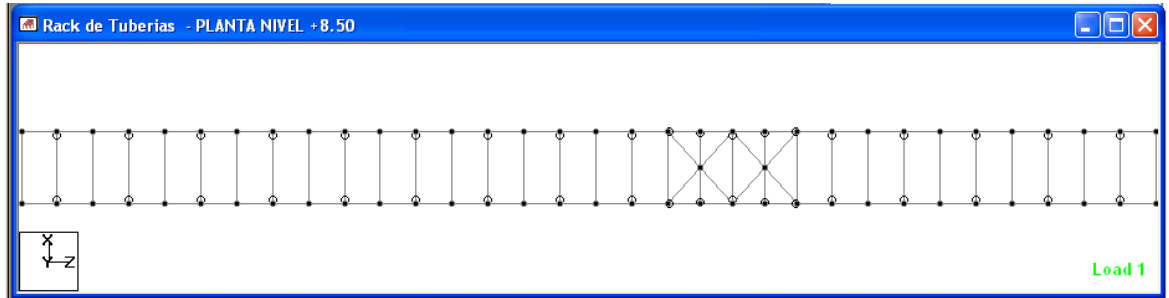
Modelo analítico planta estructural nivel 8.60
